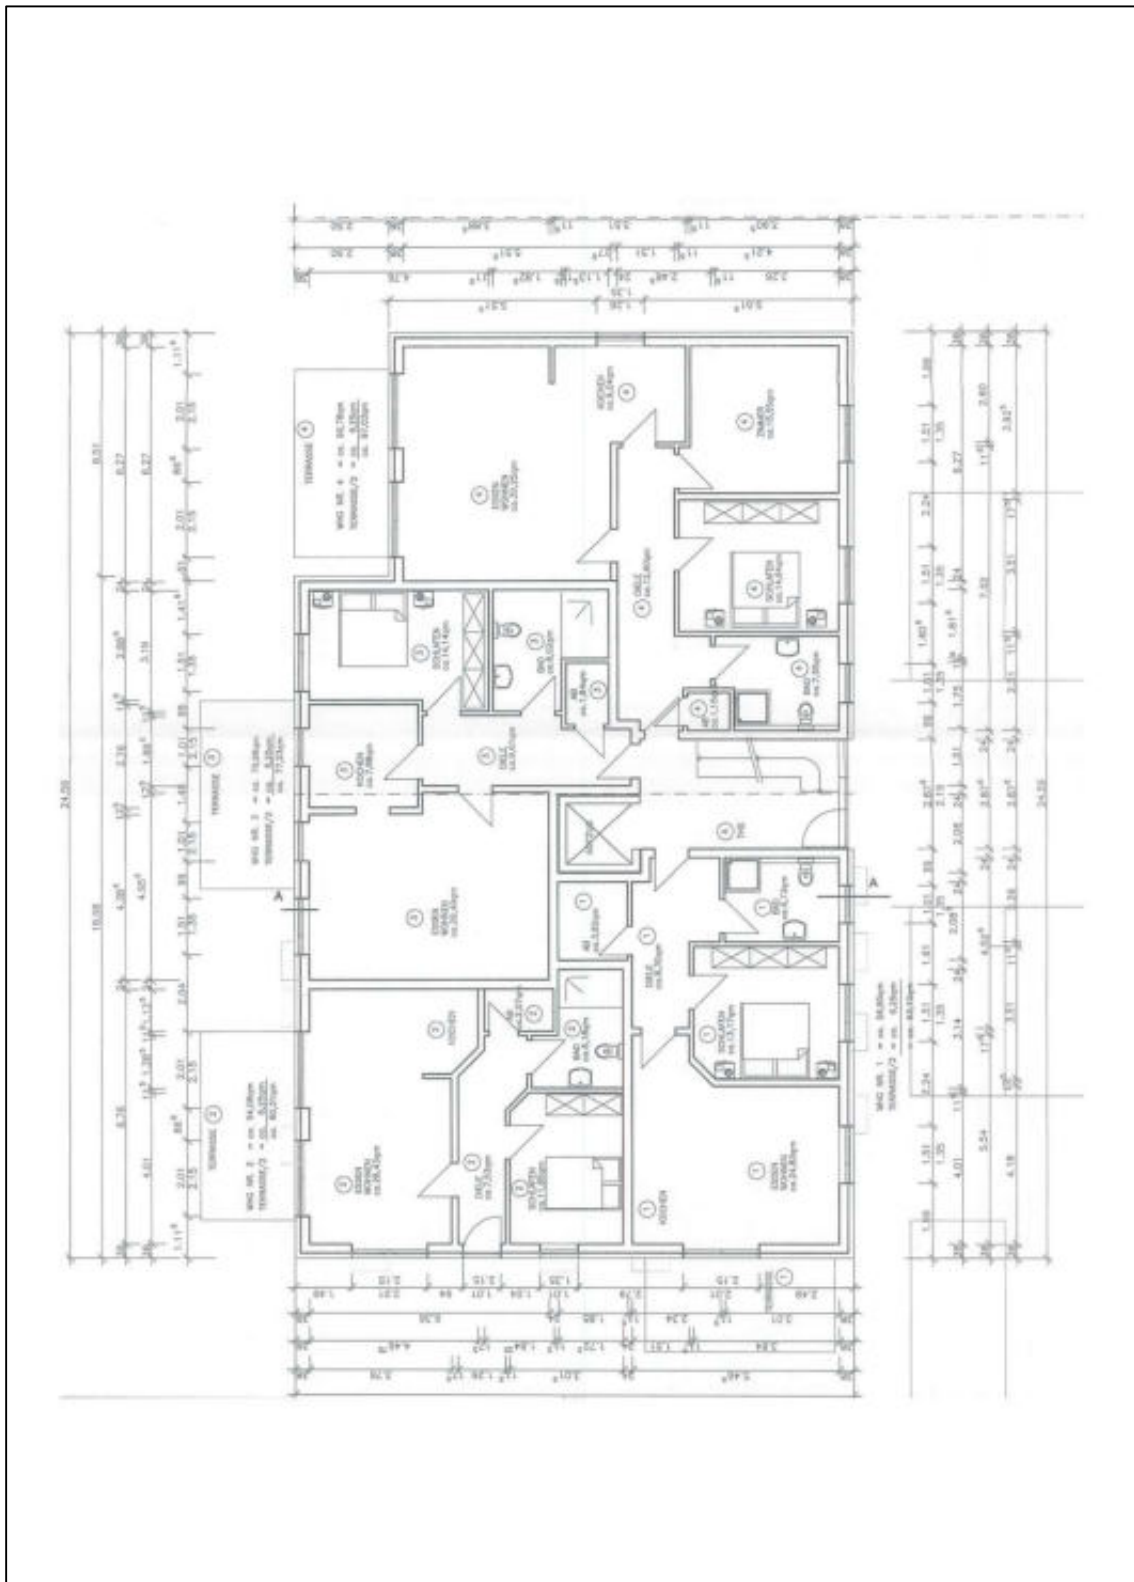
Grundriss vom Erdgeschoss
